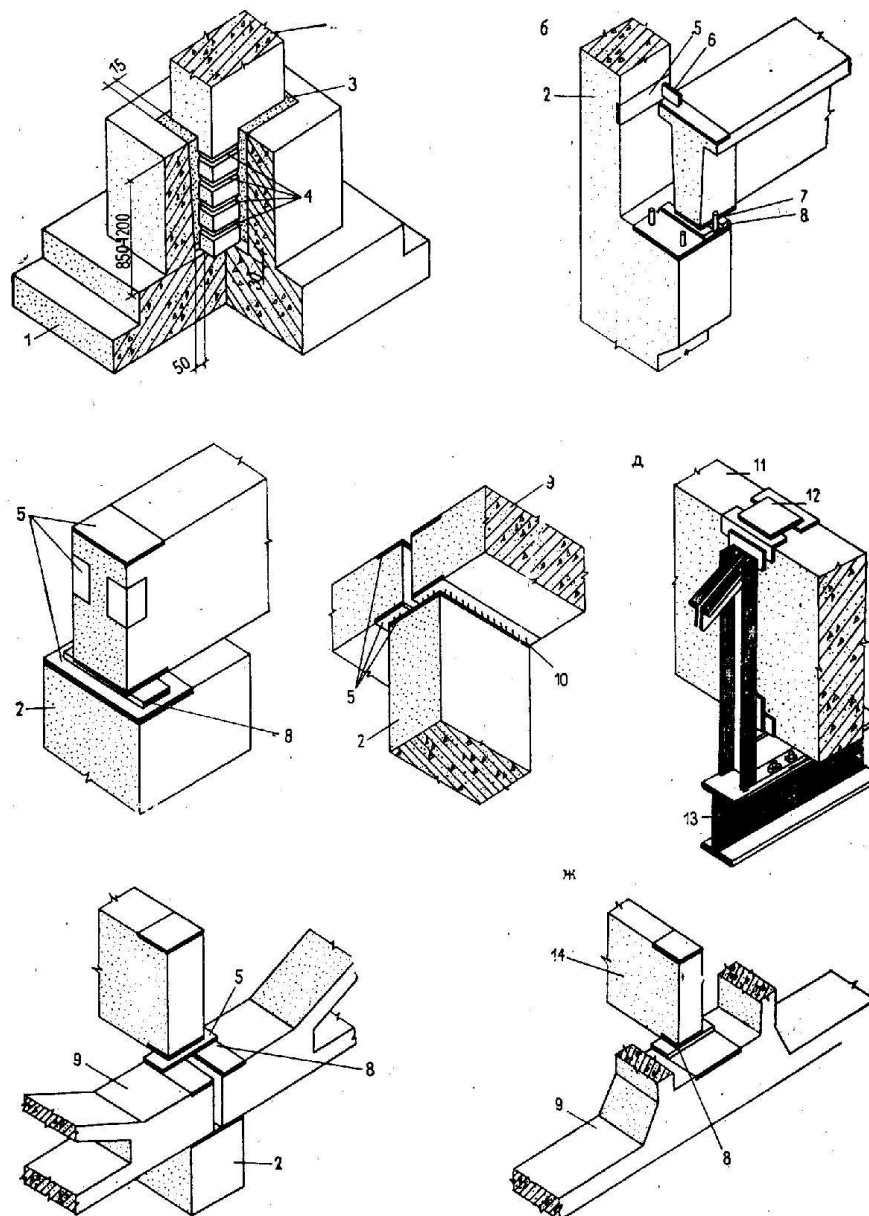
Узлы железобетонного каркаса одноэтажных промышленных зданий
